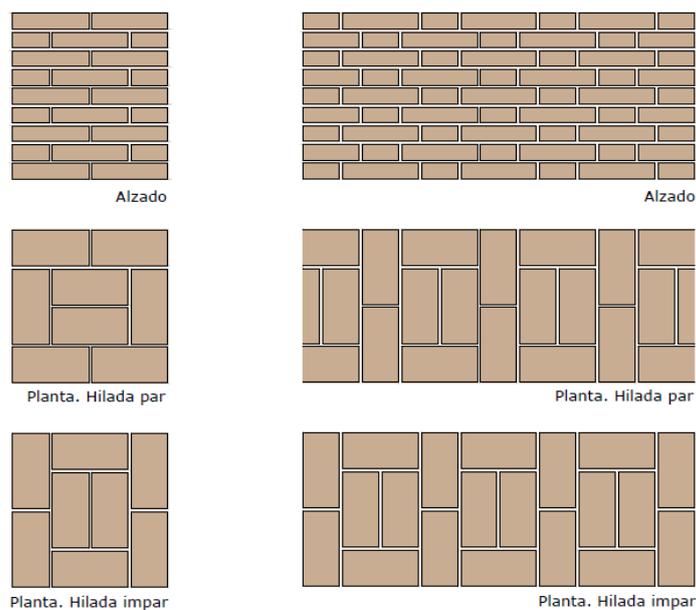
Detalles de los aparejos de soportes y muro de carga. 2015.
